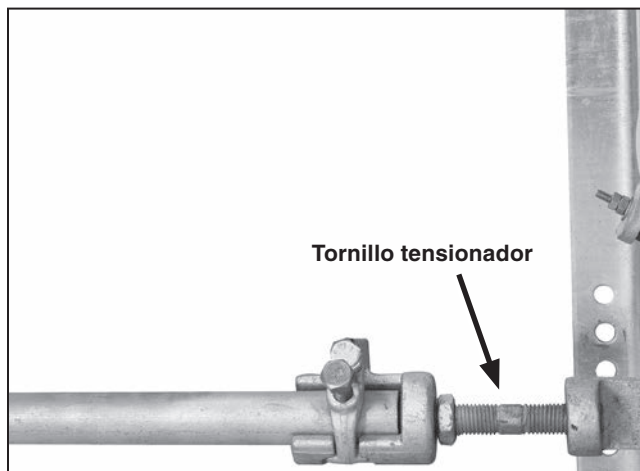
Tornillo tensionador del acoplamiento ajustable del tubo.
